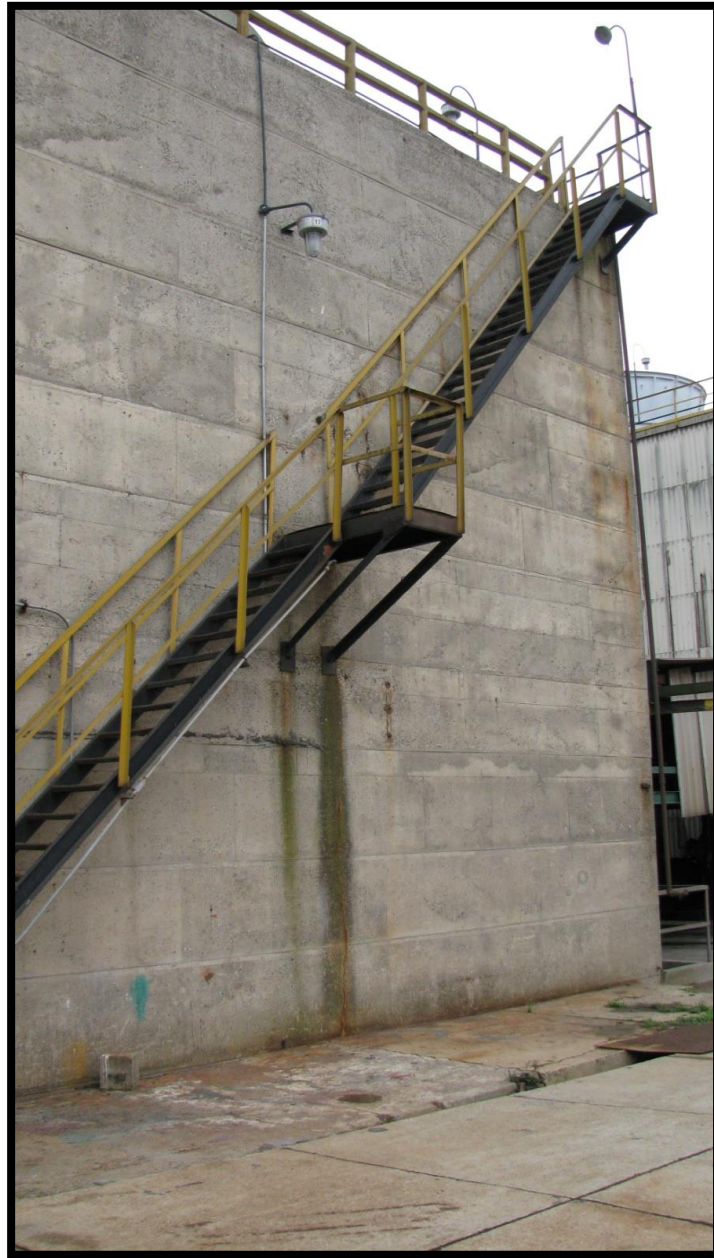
Fotografía del muro del costado sur (Fuente: el autor).
